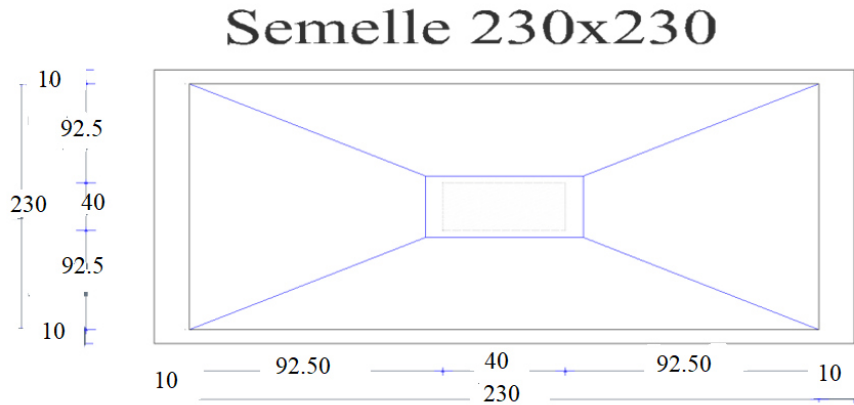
schéma de ferrailage semelle isolée sous poteau
